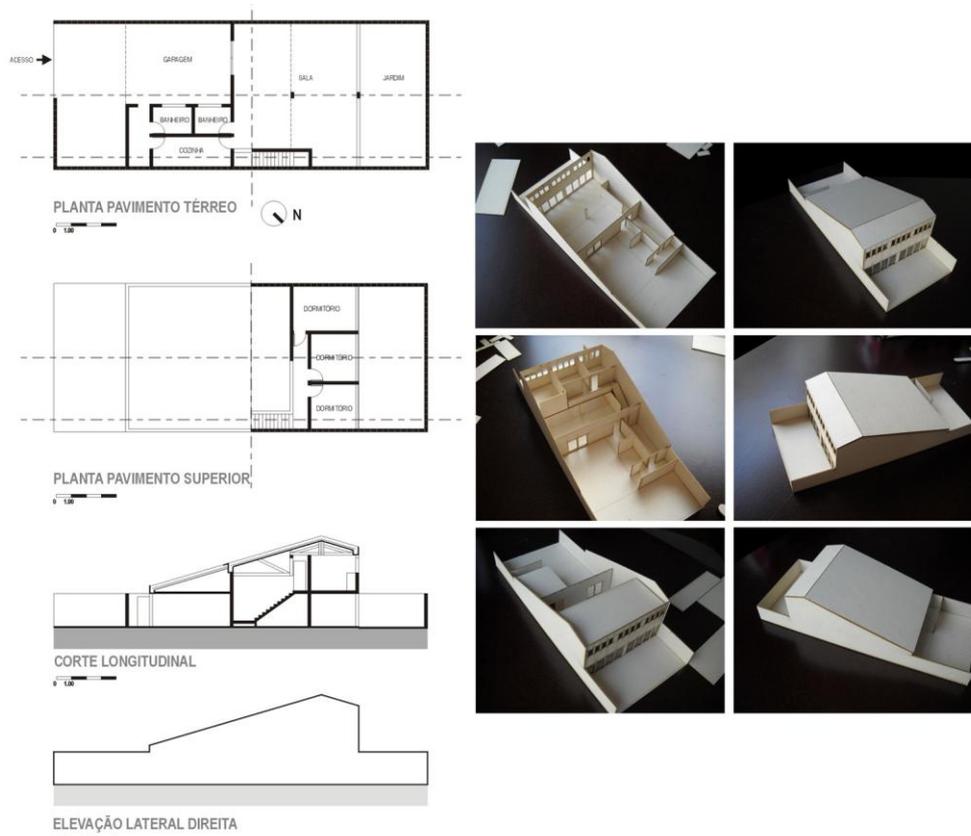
Planta, corte e elevação projeto para residência Márcia Nemes Yano, 1974.
